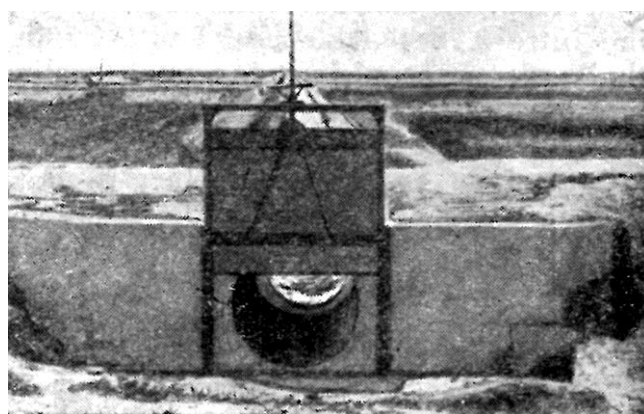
Stăvilă tubulară din elemente de beton prefabricate, la sistemul de irigații Domnești
